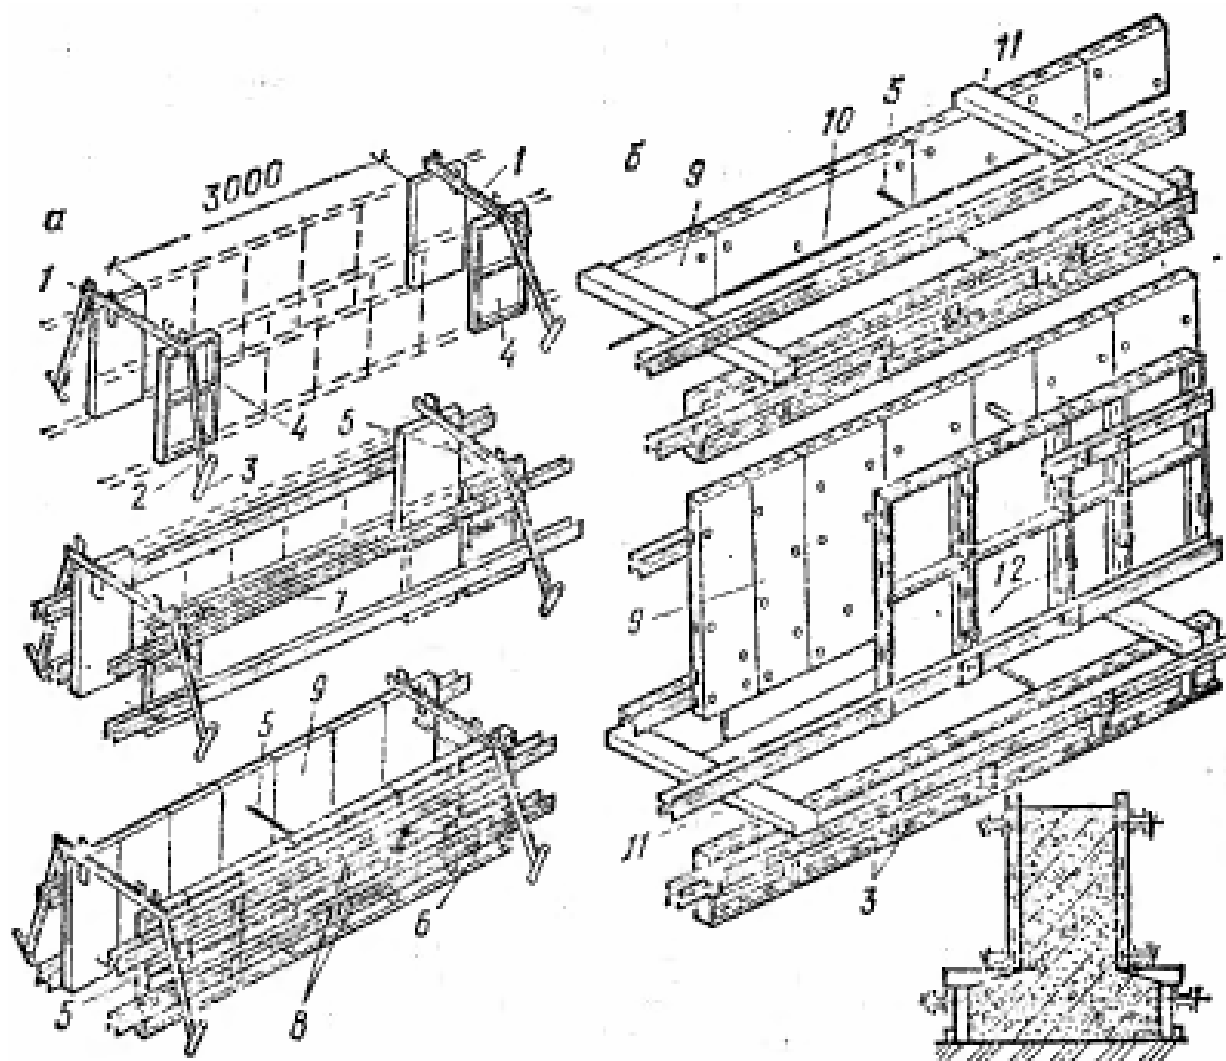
Порядок сборки опалубки ленточных фундаментов: *а* – прямоугольного поперечного сечения; *б* – таврового поперечного сечения; 1 – временные распорки; 2 – подкос; 3 – якорь; 4 – маячные щиты; 5 – стяжка; 6 – натяжные крюки; 7 – схватки; 8 – клиновые зажимы; 9 – инвентарные щиты; 10 – схватка второй ступени; 11 – перемычка; 12 – замки
